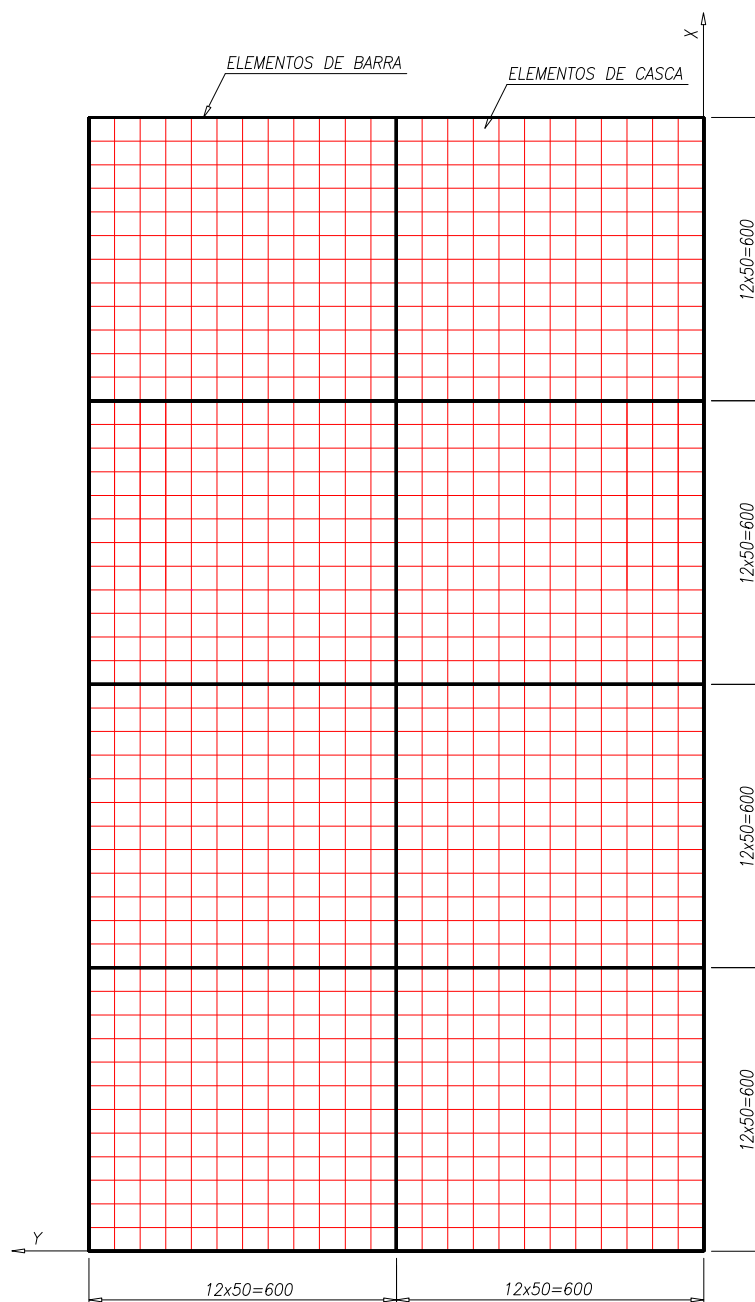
Representação Esquemática da Malha de Elementos Finitos Utilizada na Discretização da Laje e Vigas do 16º Andar (Cotas em Centímetro)
